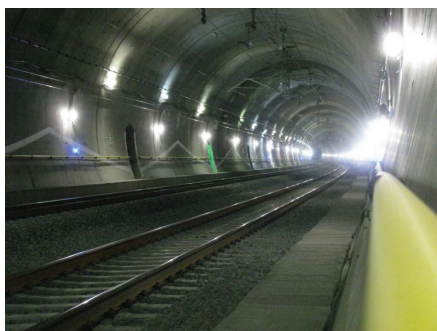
Impianto d'illuminazione in galleria. *Tunnel lighting installation.
